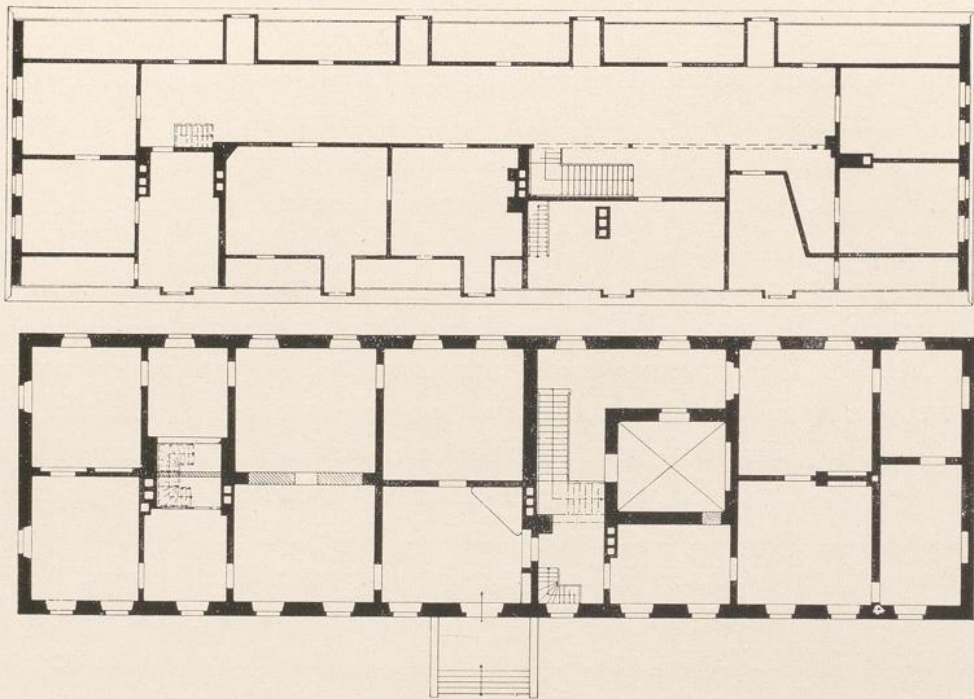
Scheegeln. Dachgeschoß. Erdgeschoß
